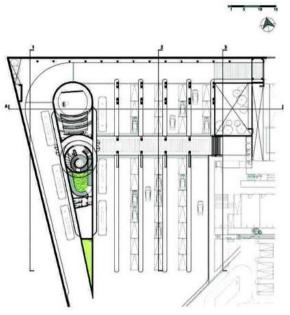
Planta arquitectónica Kinder Sinaí. Fuente: El Paralex. Escala: S/E.
